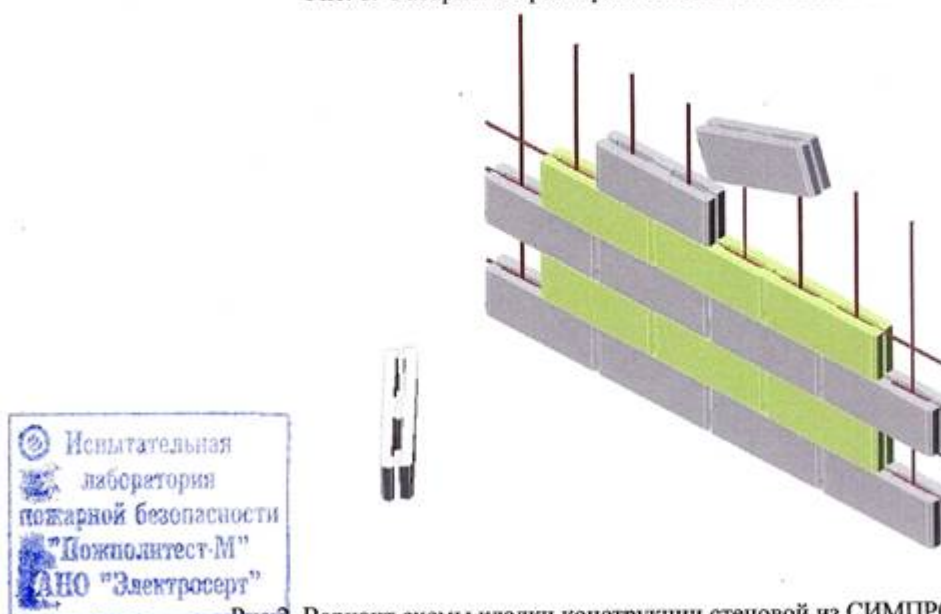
Вариант схемы кладки конструкции стеновой из СИМПРОЛИТ блоков.
